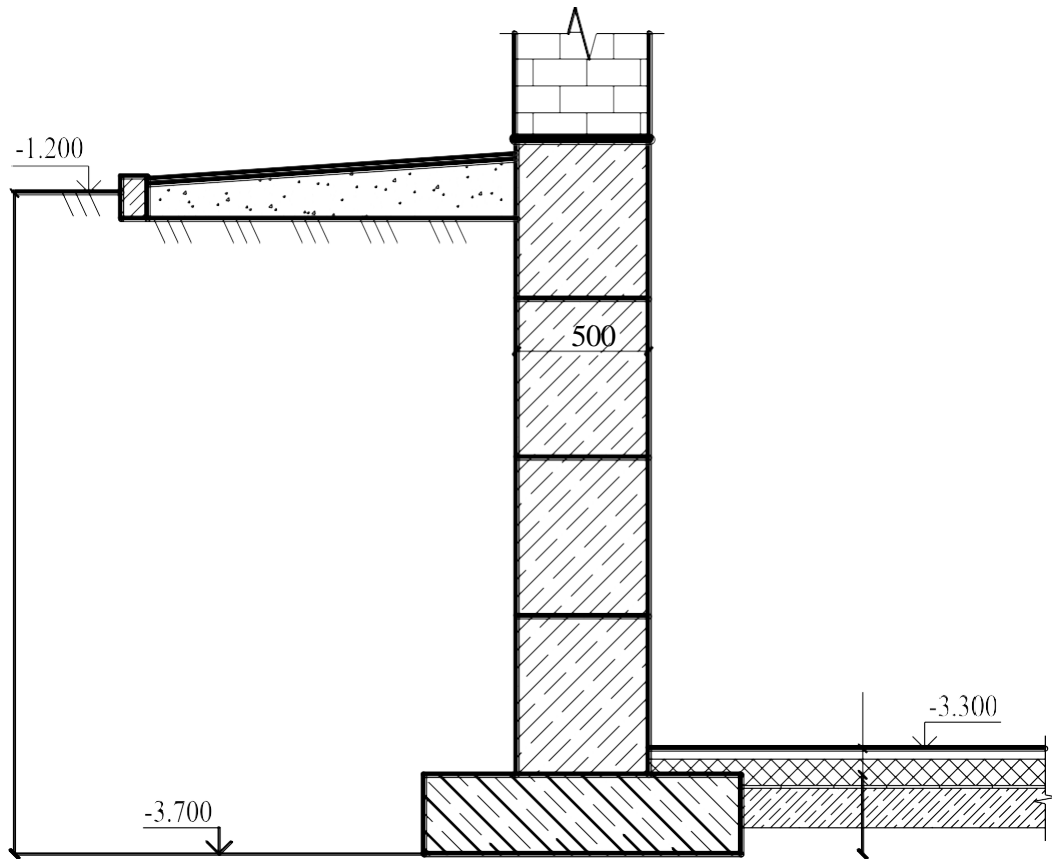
Розрахункова схема до визначення глибини закладання фундаменту
